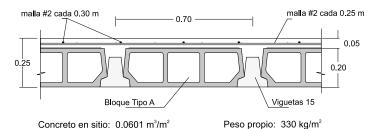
Detalle típico de entrepiso de vigueta de 15 cm con bloque tipo A
